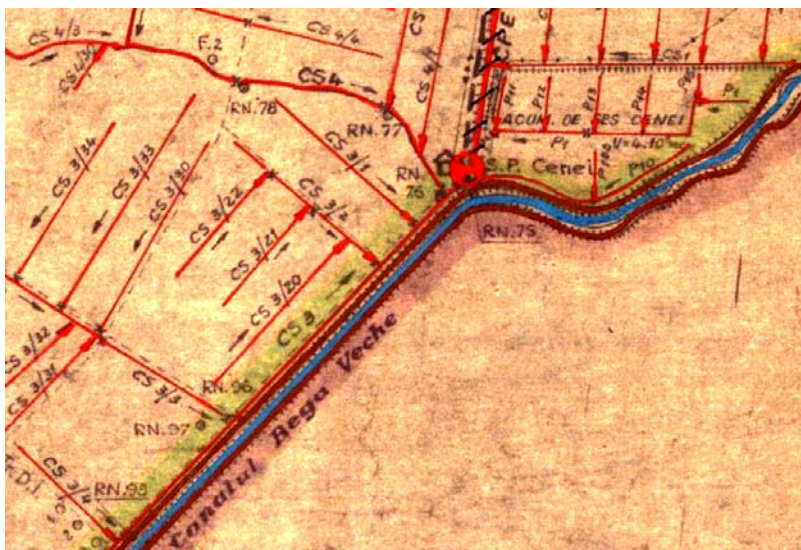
Plan de încadrare - Acumularea de șes Cenei, Sursa ANIF
